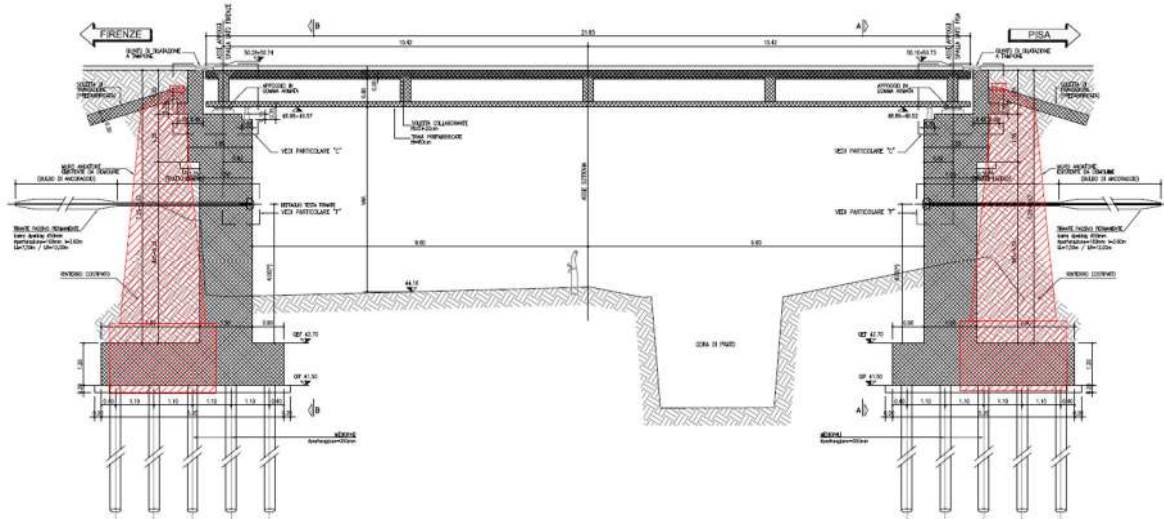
Sezioni longitudinale impalcato con spalle
